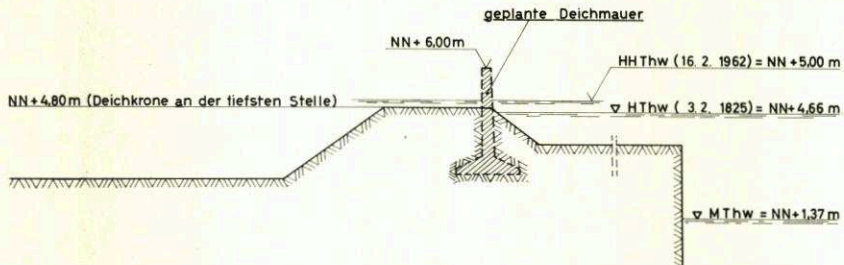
Geplante Erhöhung des Deiches im Stadtgebiet von Cuxhaven durch eine Stahlbetonmauer
